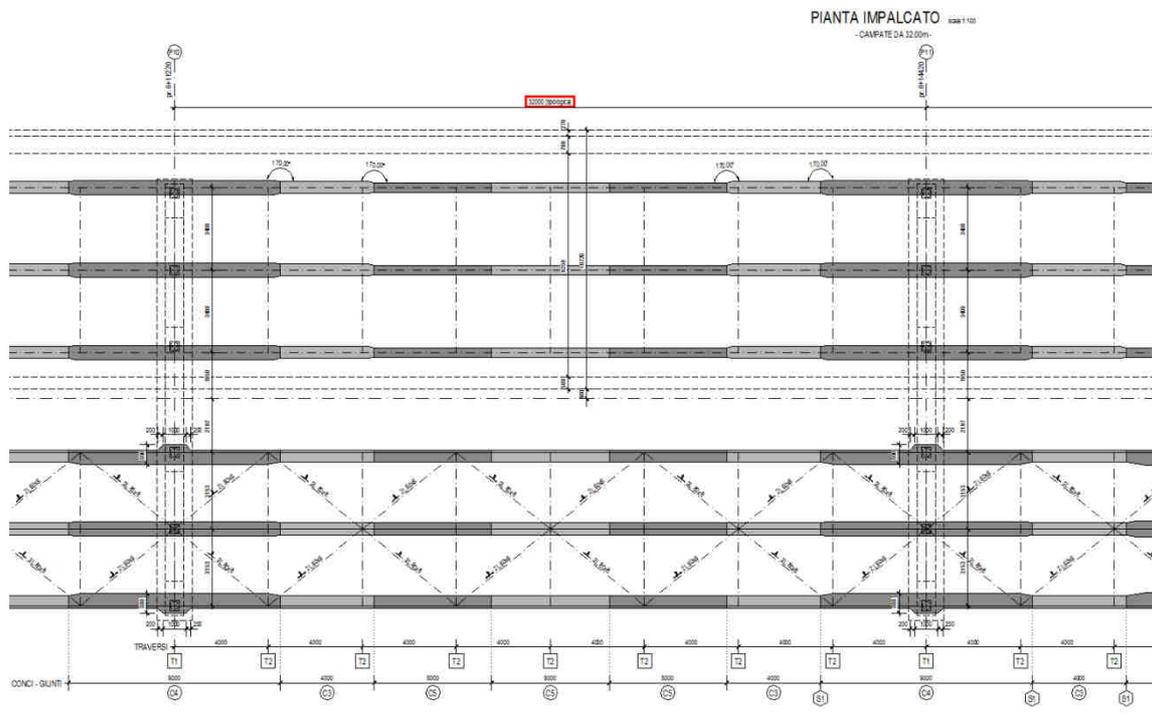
Dettaglio impalcato in acciaio - Campata tipica da 32,0m
